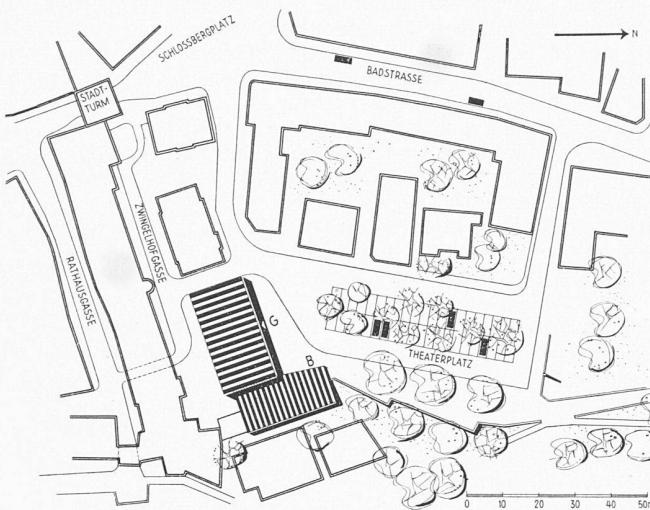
Lageplan, Maßstab 1:2000. G bezeichnet das hier dargestellte Geschäftshaus, B das zukünftige Bezirksgebäude
